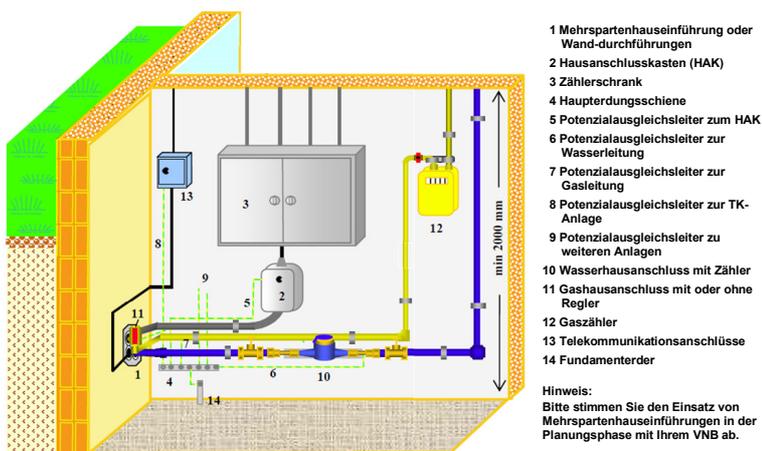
Gemeinsame Hausanschlussstrasse auf dem Privatgrundstück
